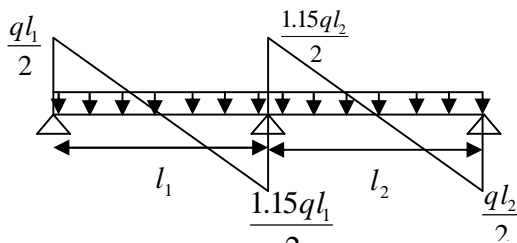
Effort tranchant sur une poutre à 2 travées
